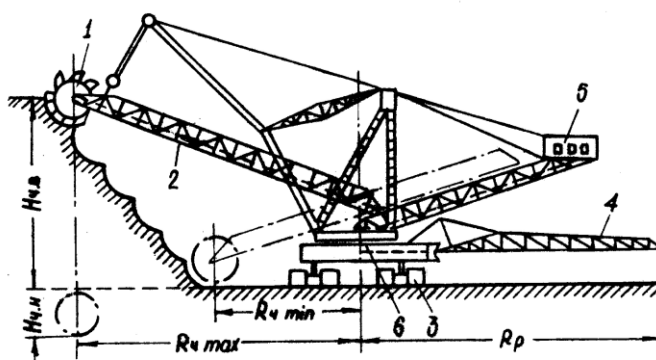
Схема роторного екскаватора: 1 – роторне колесо; 2 – стріла; 3 – гусениці; 4 – розвантажувальна консоль; 5 – противага; 6 – поворотна платформа
